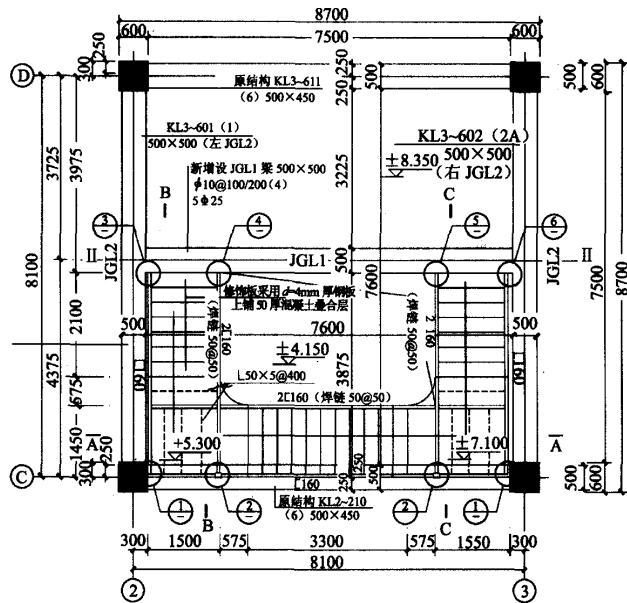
在切除楼板处拟新增设 4 号钢楼梯后的加固平面图
